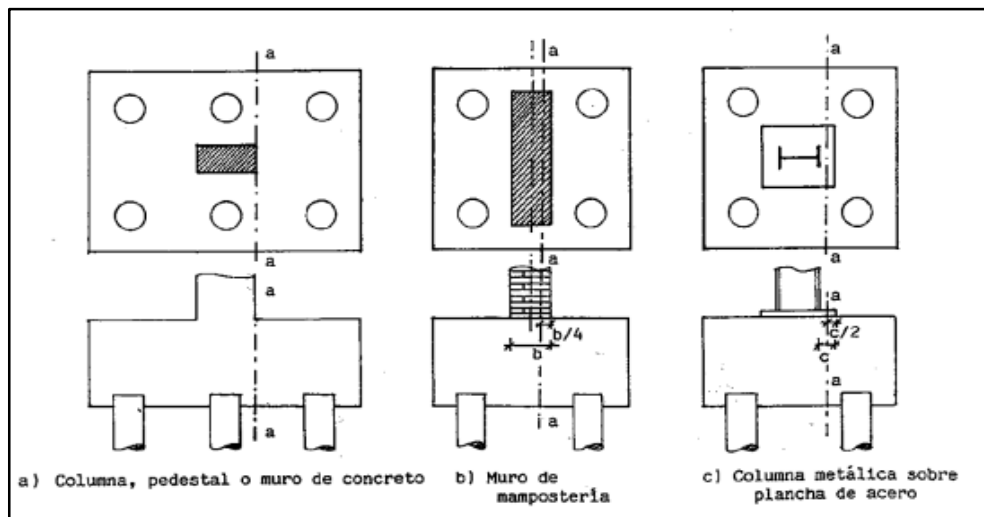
Sección crítica de la zapata representada en el corte a-a. Fuente: (ACI-318, 2014).
